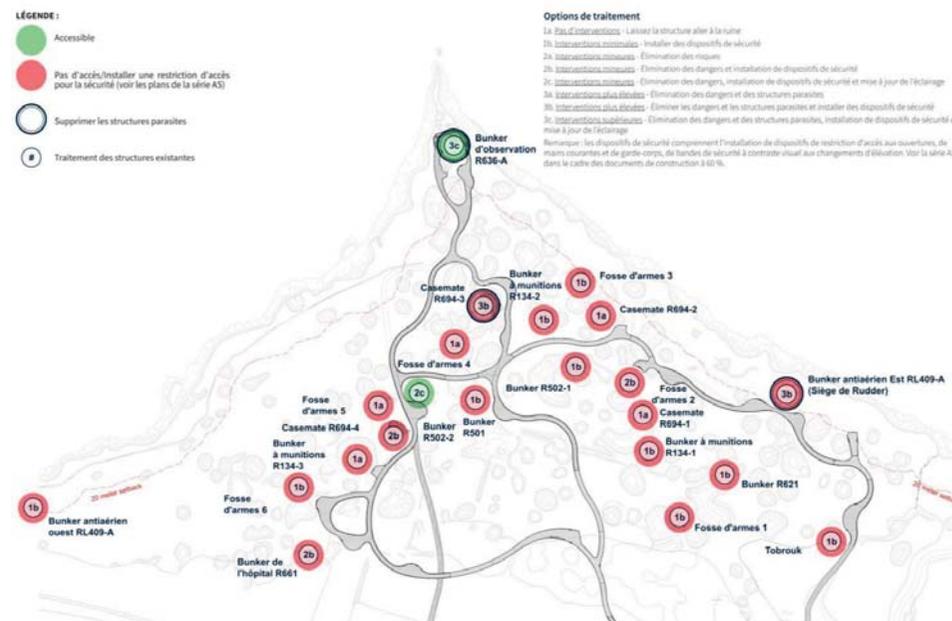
Traitement des structures existantes - Source : Permis de construire
